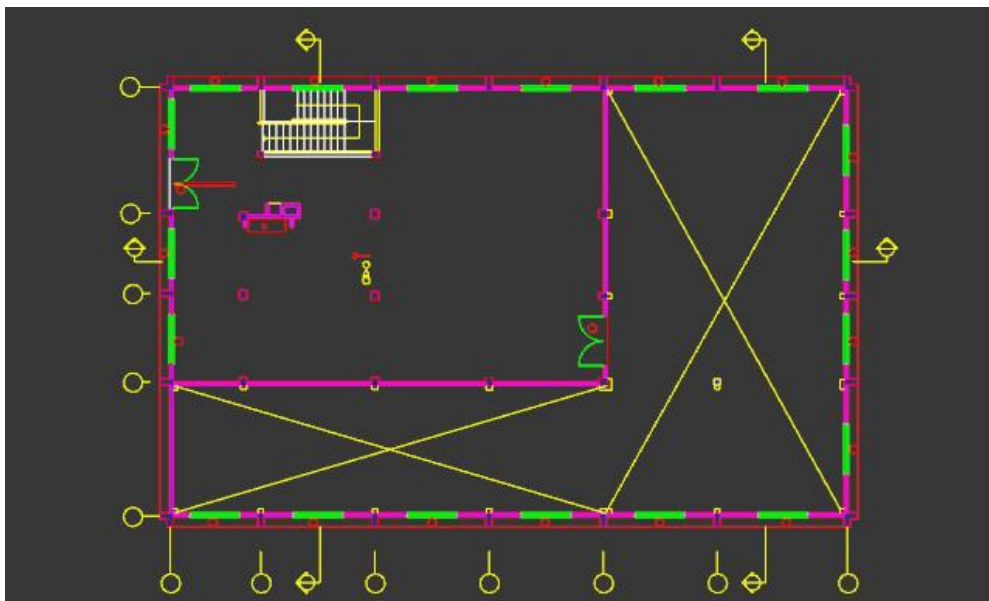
Planta retirada do modelo AutoCAD sobre a qual o projeto foi executado
